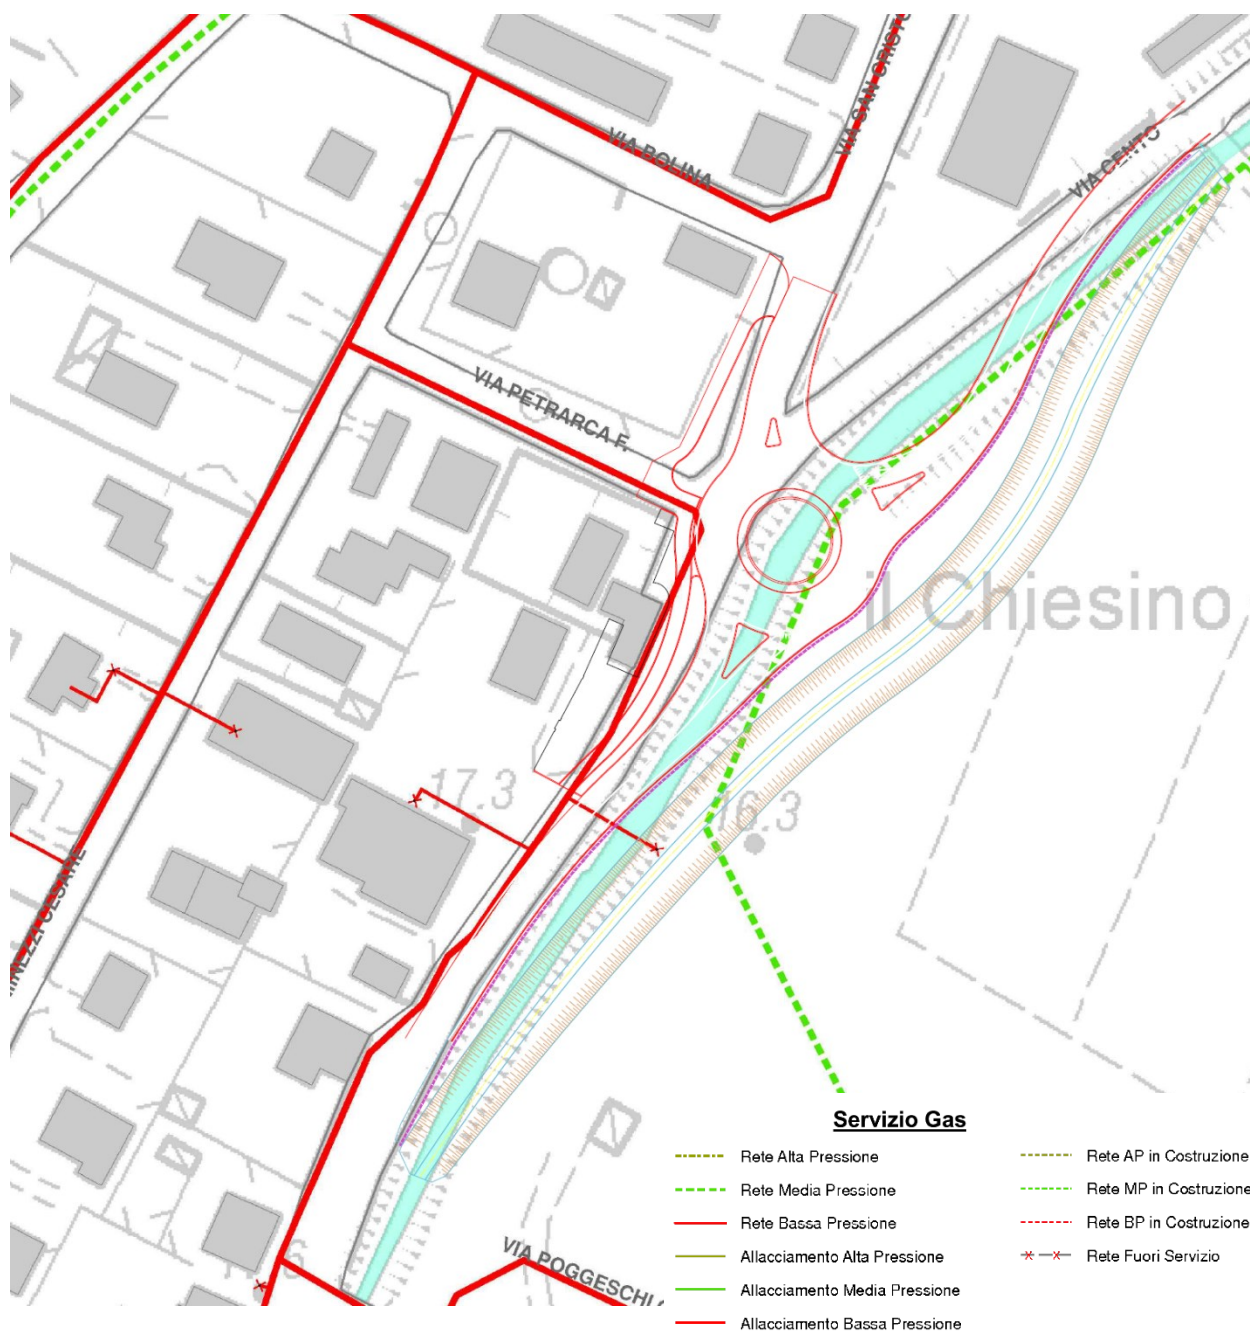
Sovrapposizione rete distribuzione gas HERA con progetto
